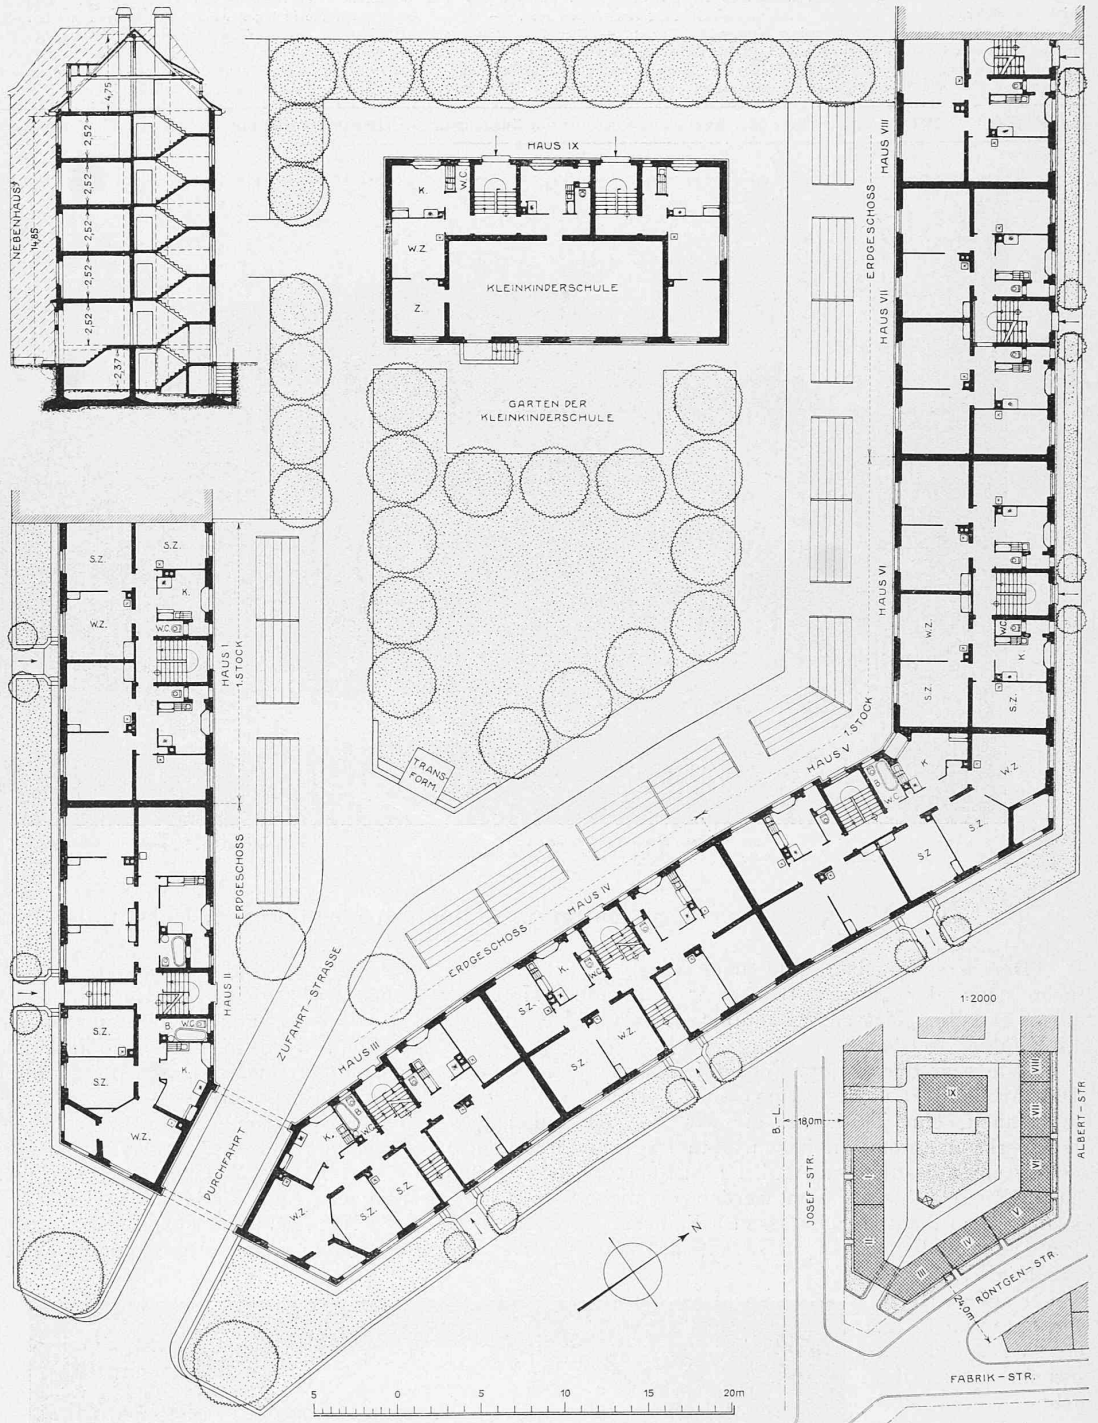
Grundrisse und Schnitt, Masstab 1:400.
